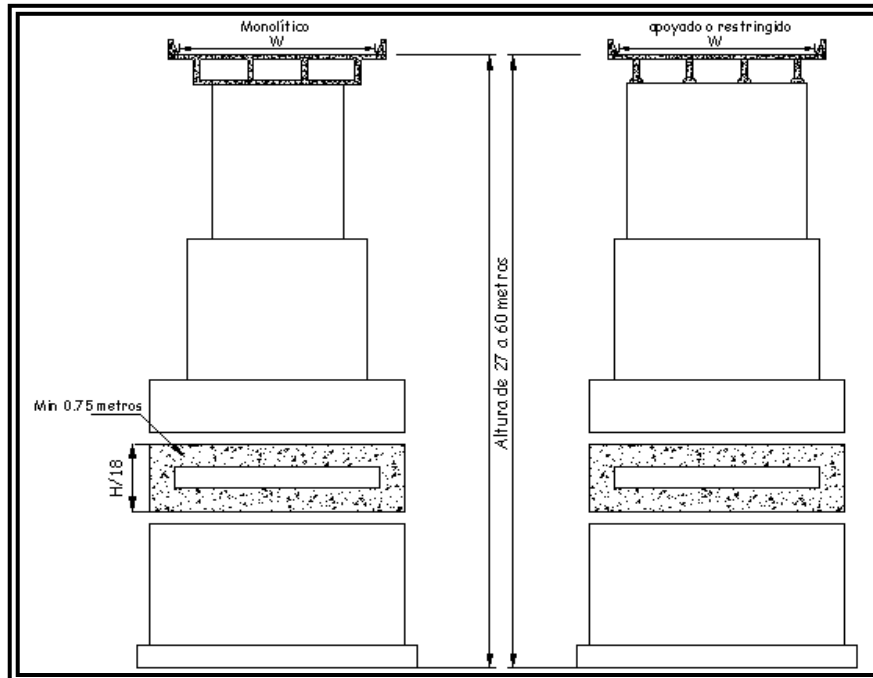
Pila de sección de cajas huecas. ²⁶⁷
